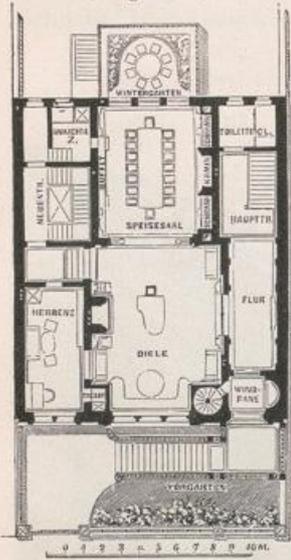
Idealentwurf für ein Dreifensterhaus von EBE und BENDA (Untergeschöß).
